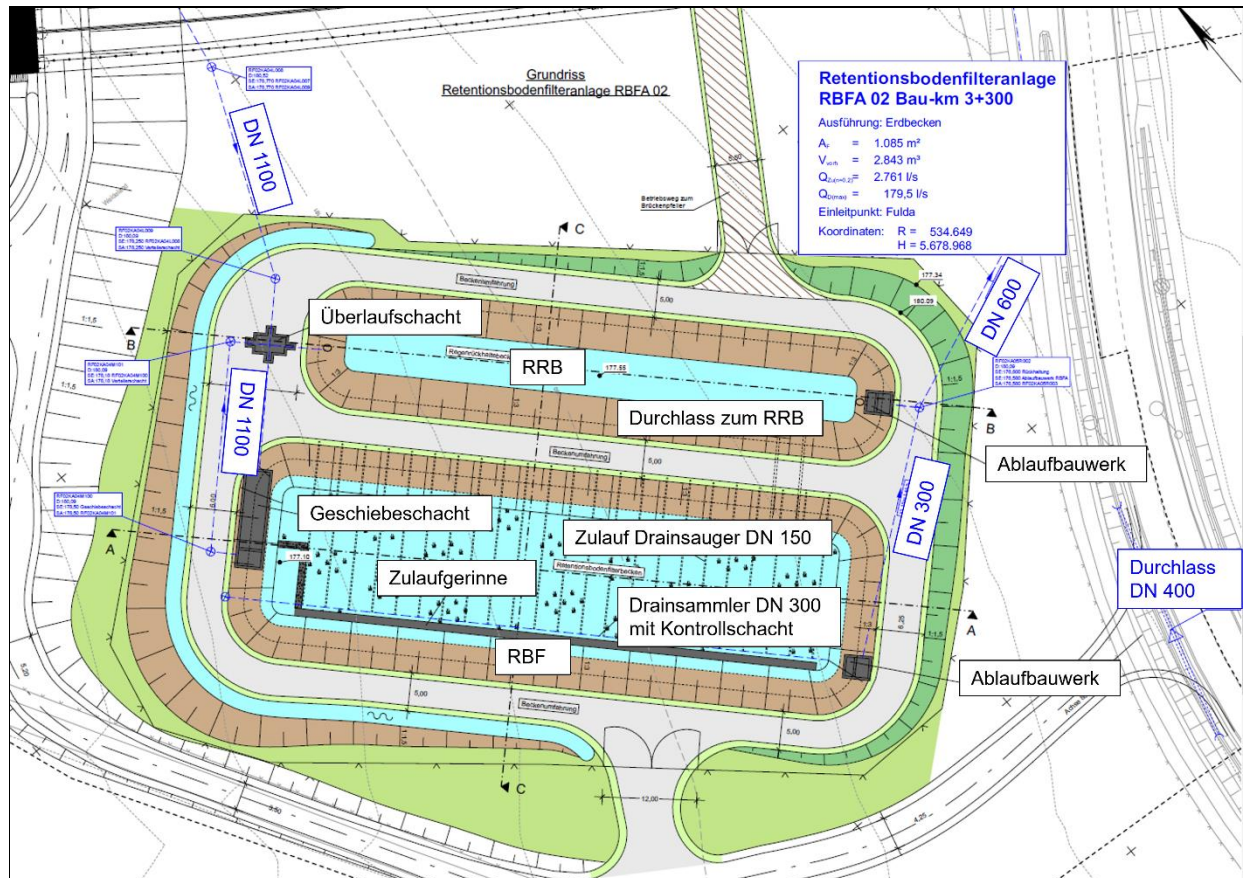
Grundriss der Retentionsbodenfilteranlage 02 (RBFA 02)
